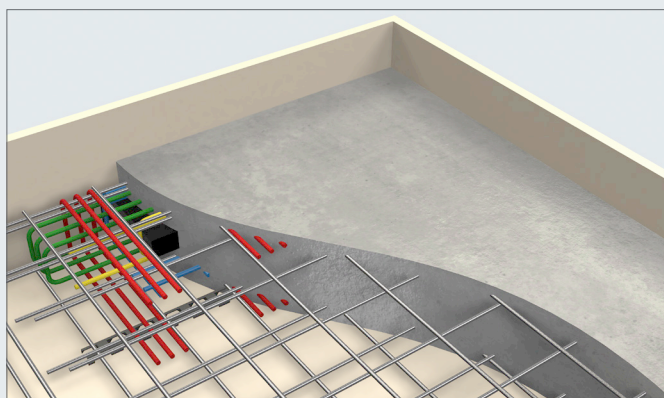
Nach dem Einbau und der Abnahme der restlichen Bewehrung kann die Platte betoniert werden.
